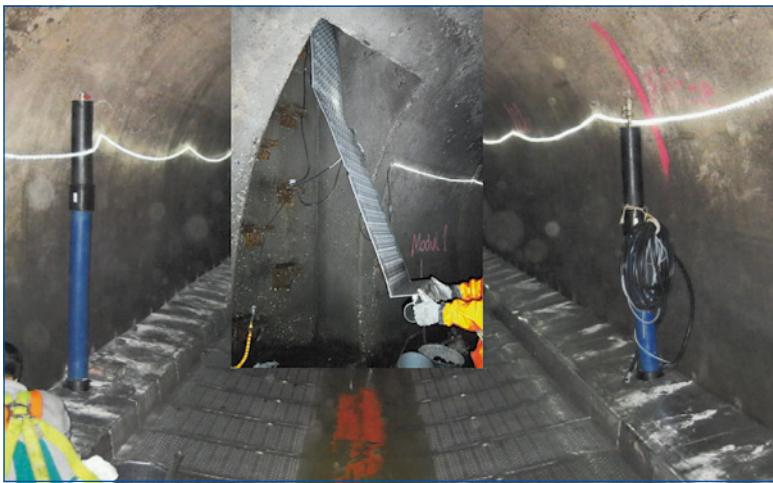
Kanalwärmetauscher – Frankfurt Speicherstraße [Fotos: EGS-plan, Stuttgart, Architekt: HHS Planer + Architekten AG, Kassel, Bauherr: ABG FRANKFURT HOLDING, Frankfurt]
